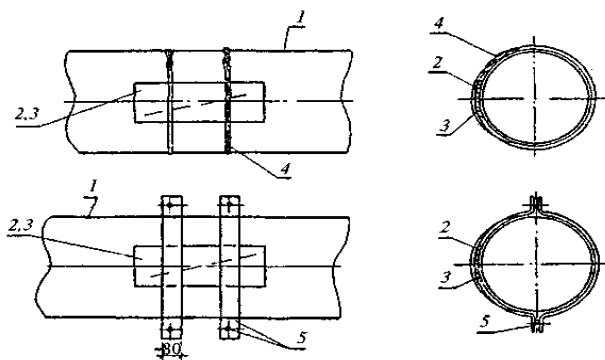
Схема заделки продольных трещин на чугунных и стальных трубопроводах
